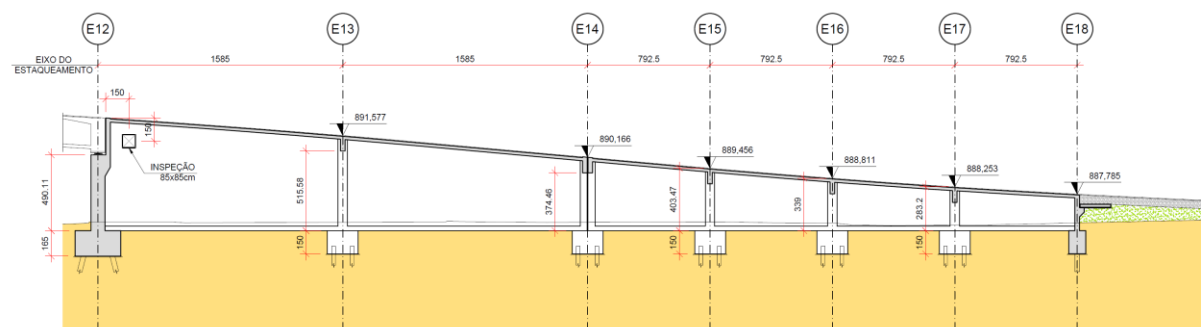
RAMO 400 - PLANTA ENCONTRO ESTRUTURADO (EIXOS E12 A E18)
